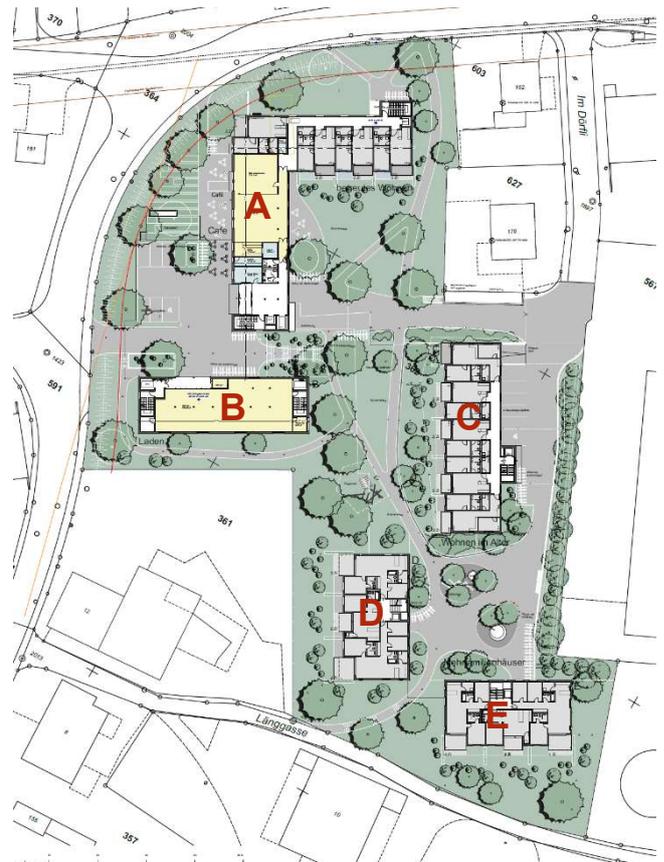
Erdgeschoss Haus A, 1. Obergeschoss Häuser B, C und D
